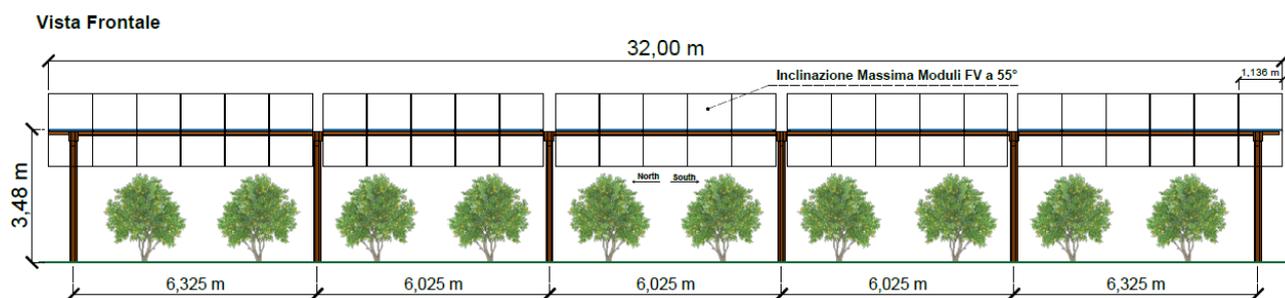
Particolare disposizione moduli su tracker in prospettiva (configurazione TRJ HT 1x27)
